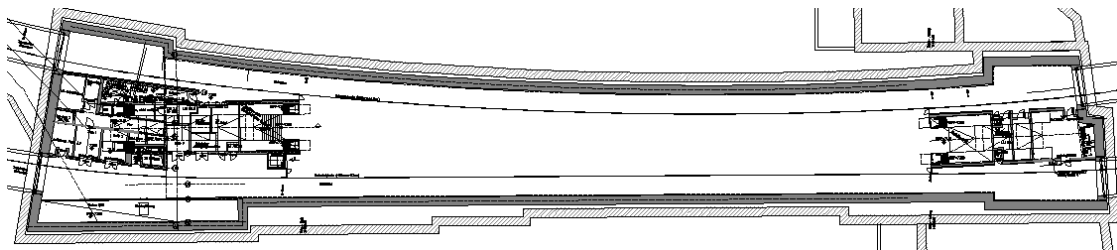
Grundriss der Fahrbene (C-Ebene) der Station „Güterplatz“
